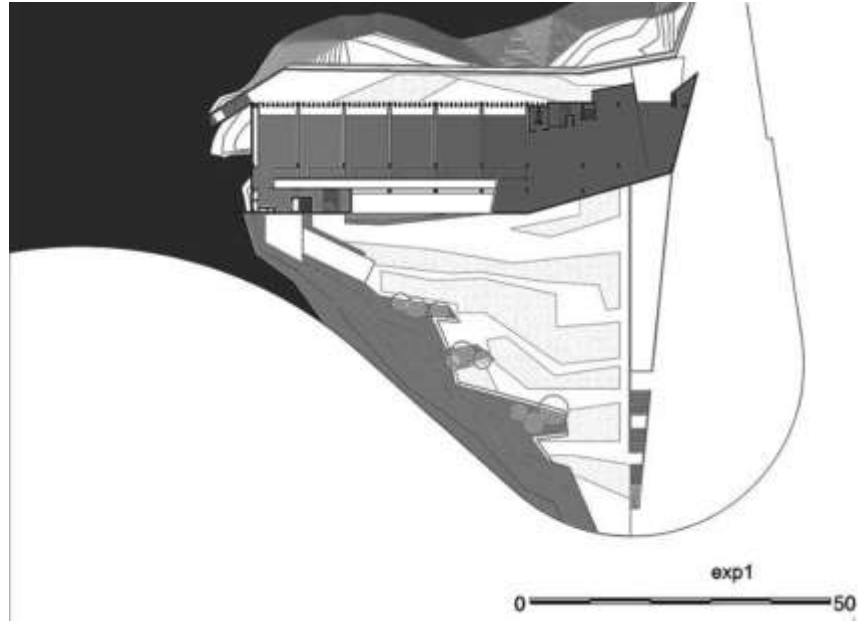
LUM. Planta salas de exposición. Nivel +4.5 m. Estudio Barclay & Crousse
